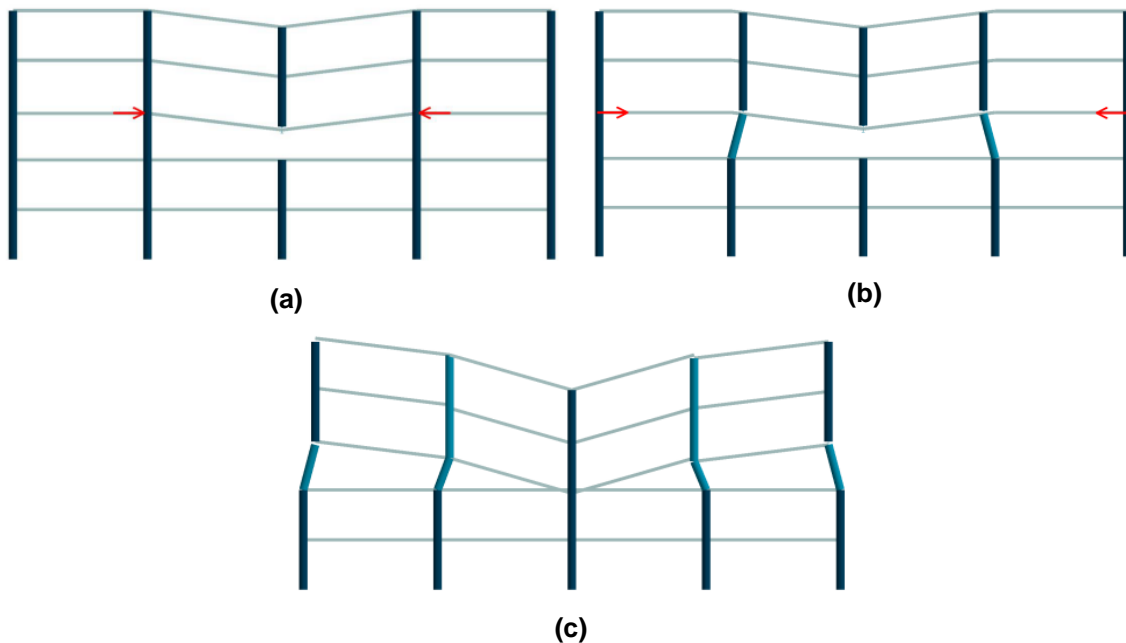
Etapas de colapso progressivo tipo dominó: (a) derrubamento inicial de um elemento; (b) derrubamento de outros elementos devido a cargas horizontais; (c) progressão da rotura na horizontal (adaptado de [10])
